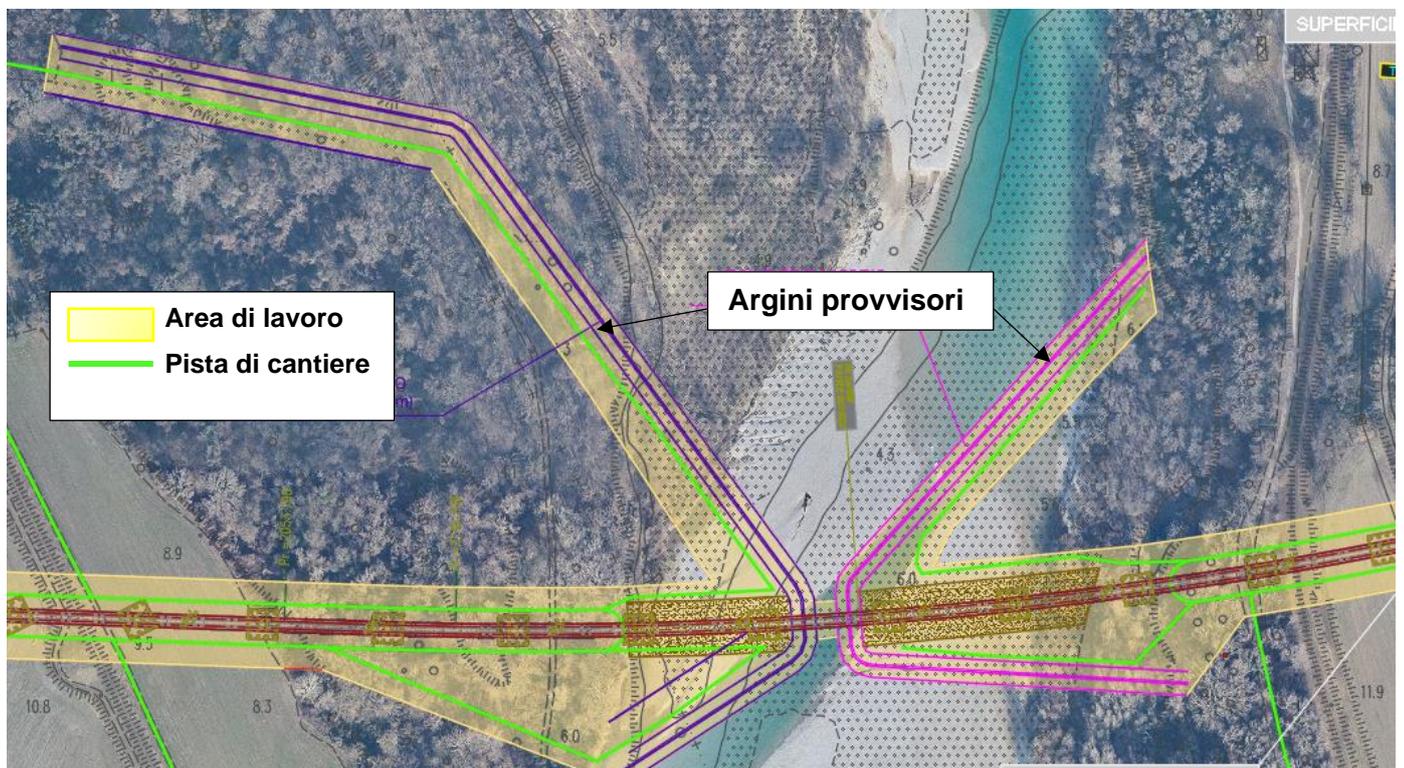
Area di lavoro prevista sul viadotto Isonzo
